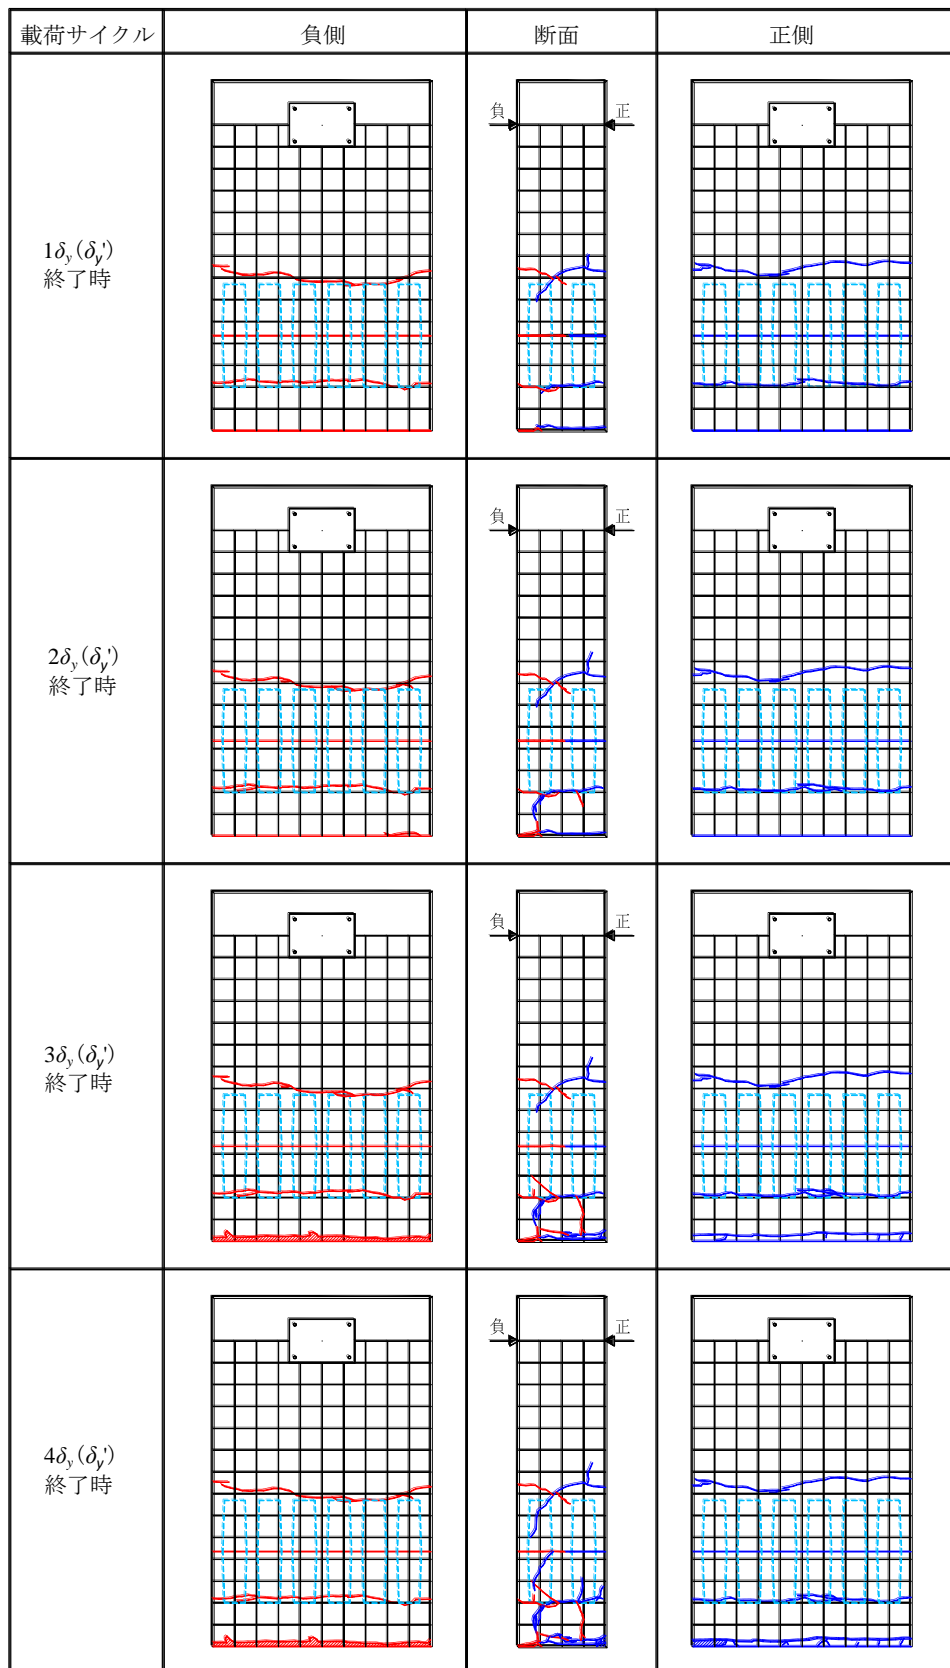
JD25A 試験体ひび割れ図 ($1\delta_y \sim 4\delta_y$)
